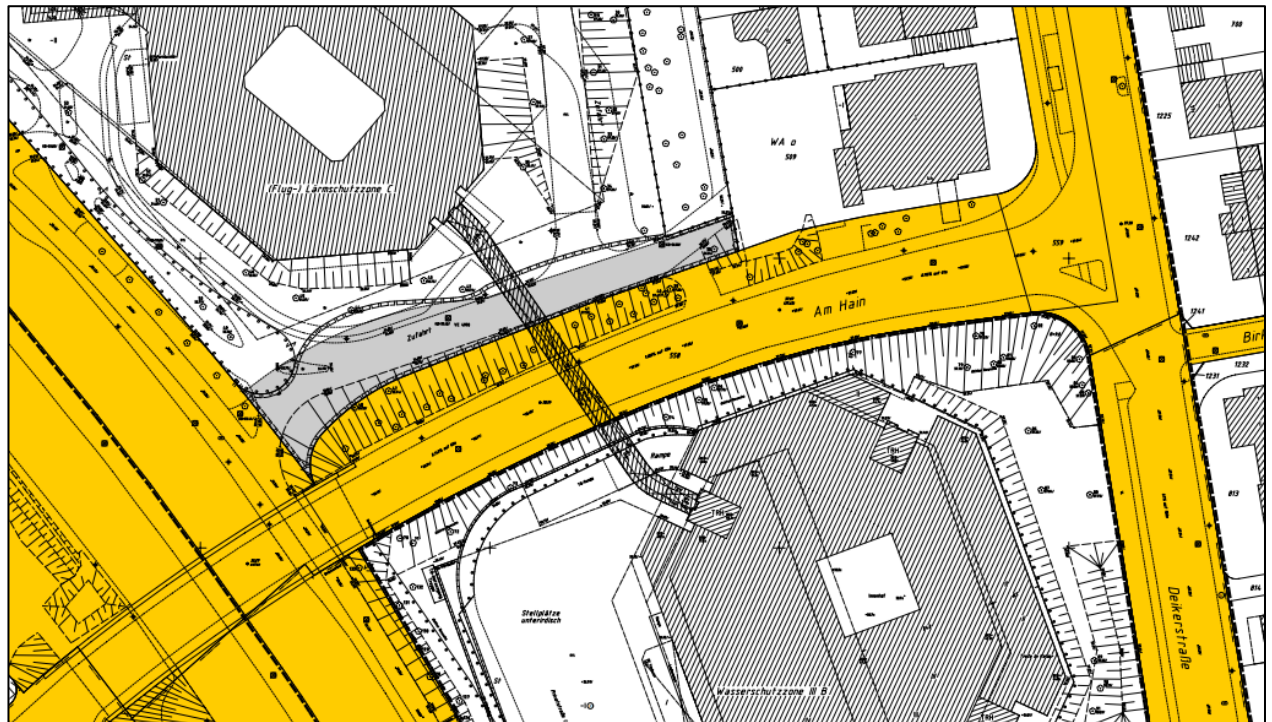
Auszug Lageplan mit Baulasteintragung
